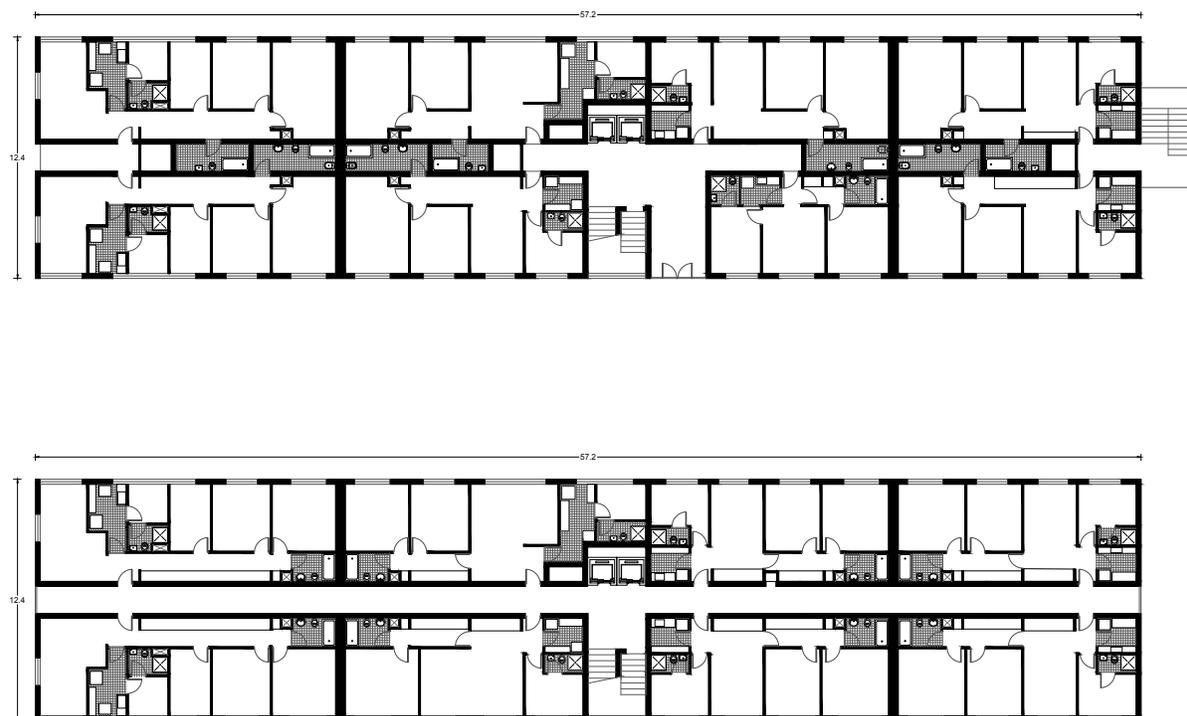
Planta 1<sup>a</sup> nivel (arriba) y Planta 7<sup>a</sup> nivel (abajo). Ambas plantas se diferencian en la disposición del pasillo central conector de todos los departamentos.
